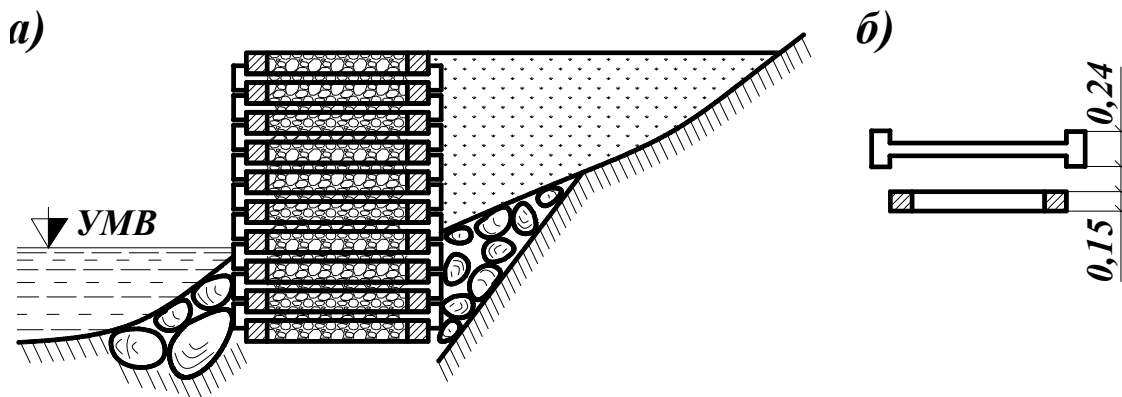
Укрепление берега железобетонными ряжами:
